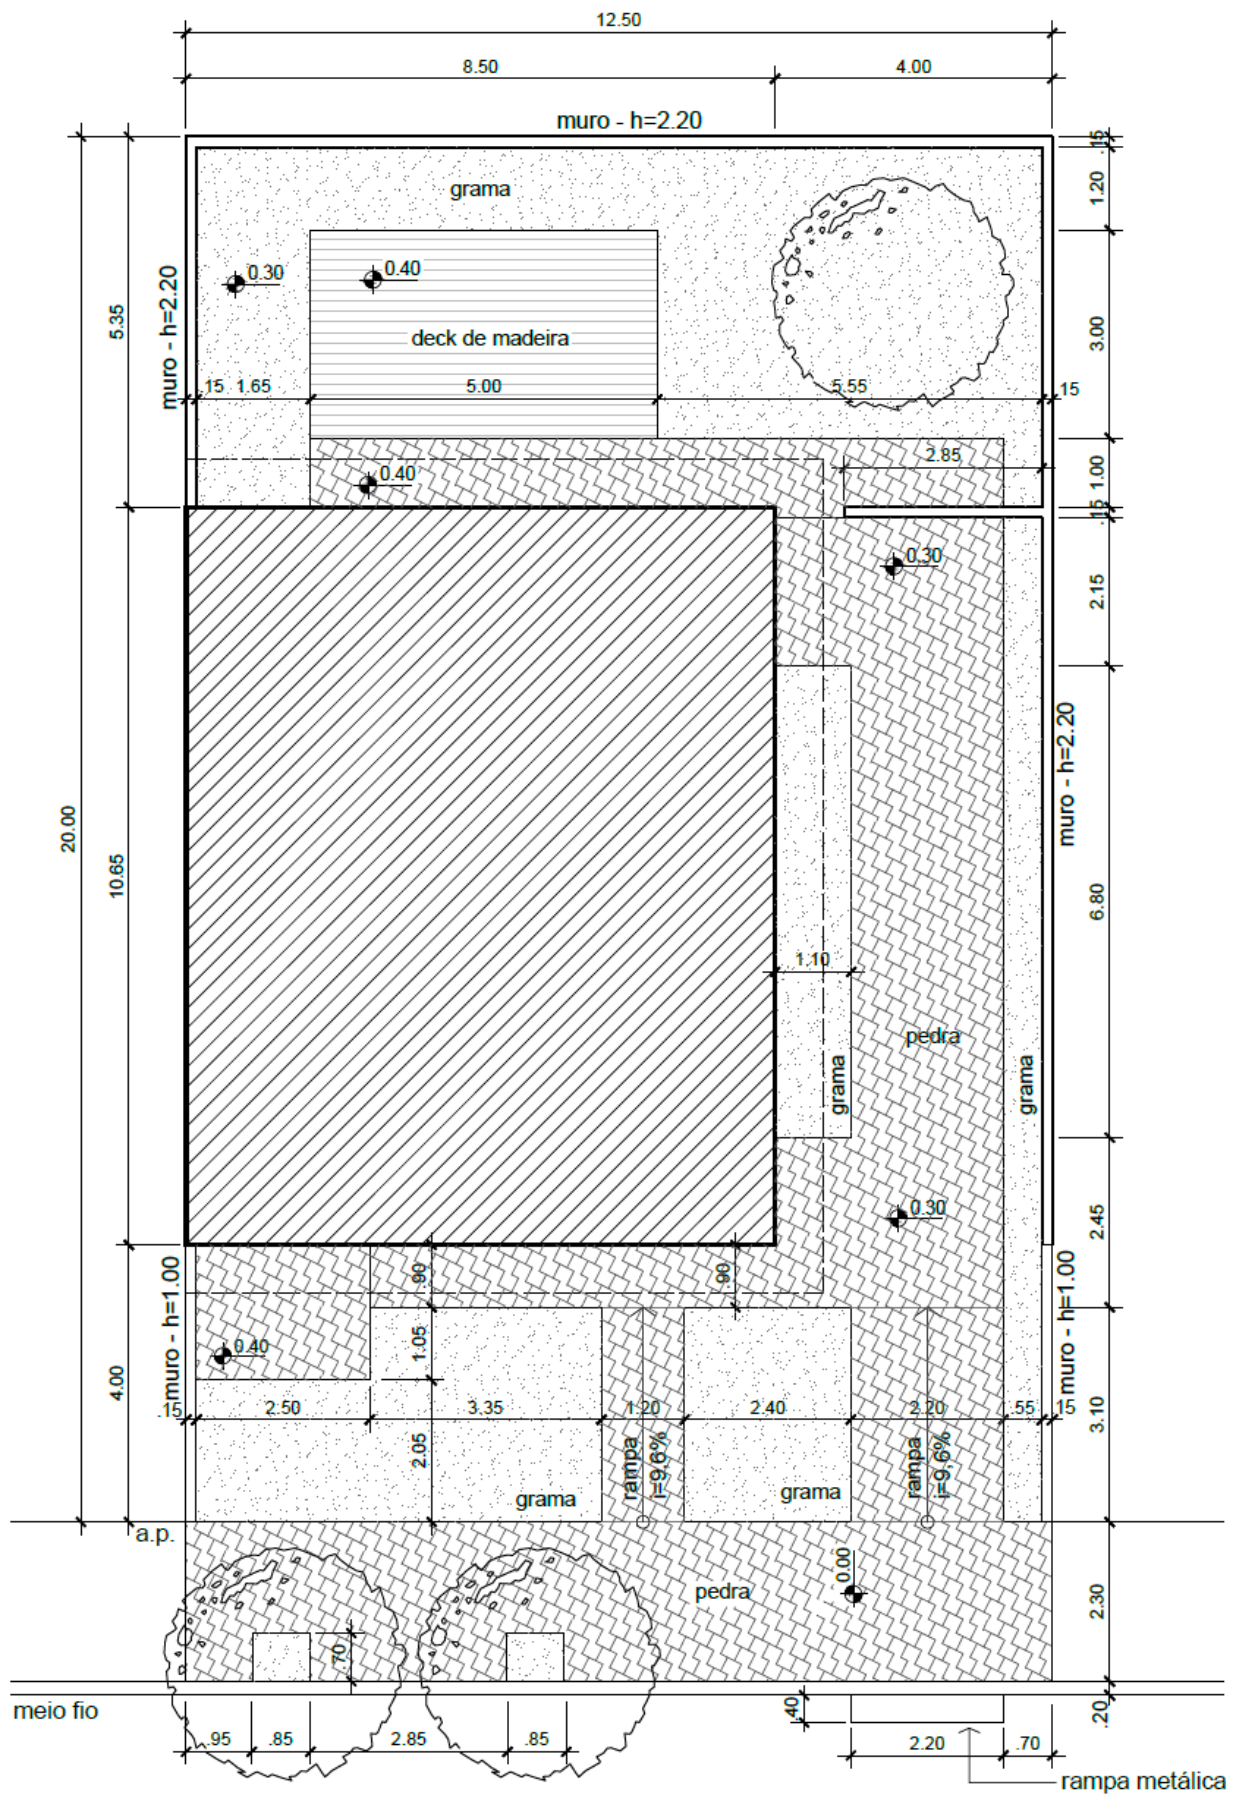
Exemplo de representação de planta de localização. Fonte: autor
